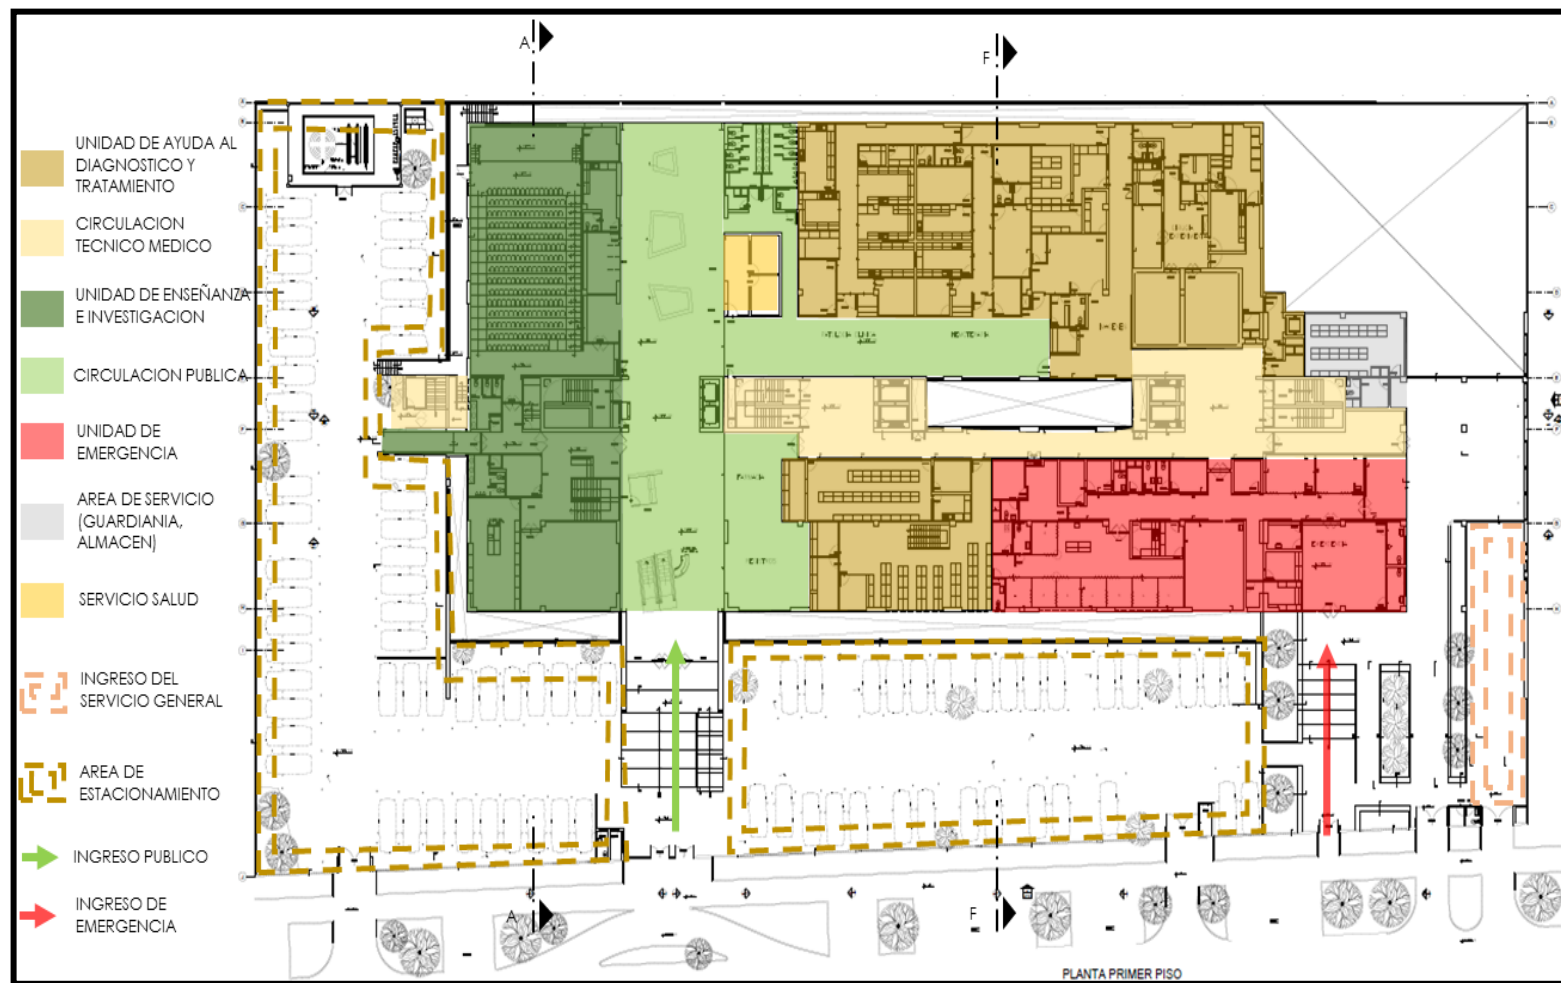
“Análisis de Casos: INCOR: Planta Primer Piso”
